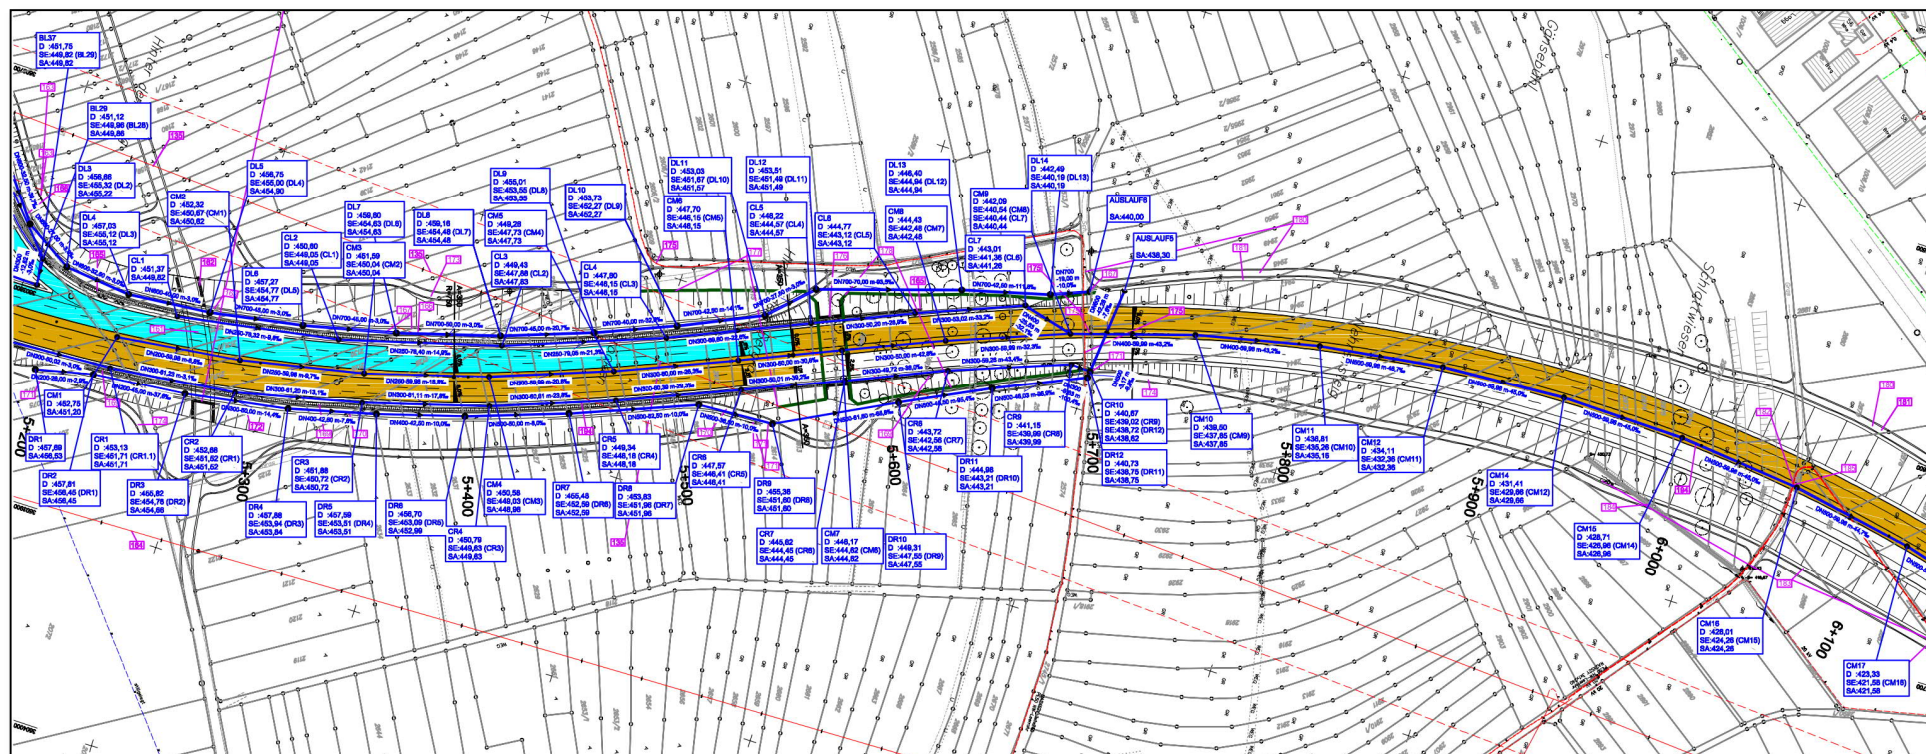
Entwässerungsabschnitt 3: Stationen 5+200 bis 6+100 Straßenflächen mit erforderlicher Behandlung (Flächen, die nicht breitflächig in den Böschungen zur Versickerung gebracht werden können). Ohne Maßstab
